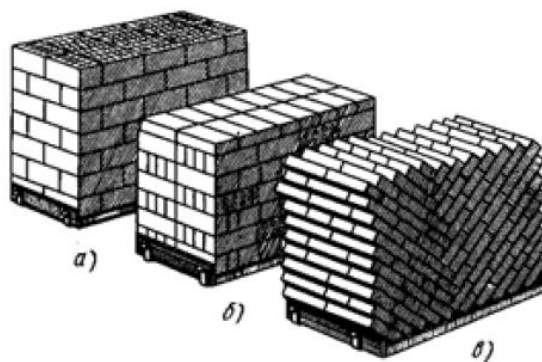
Укладка на поддонах кирпича с перевязкой а, б – перекрестная перевязка; в - "в елку"
